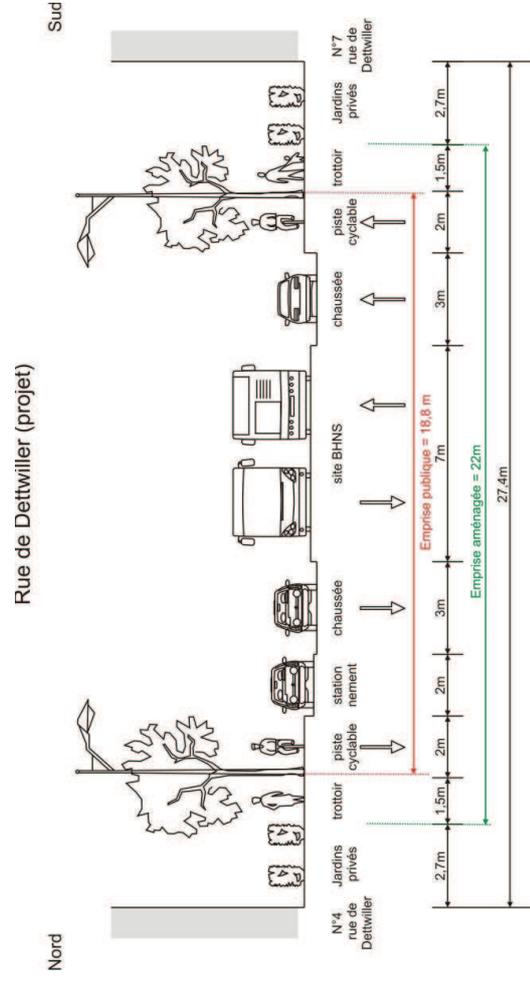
Situation projetée (coupe 33) rue de Dettwiller
